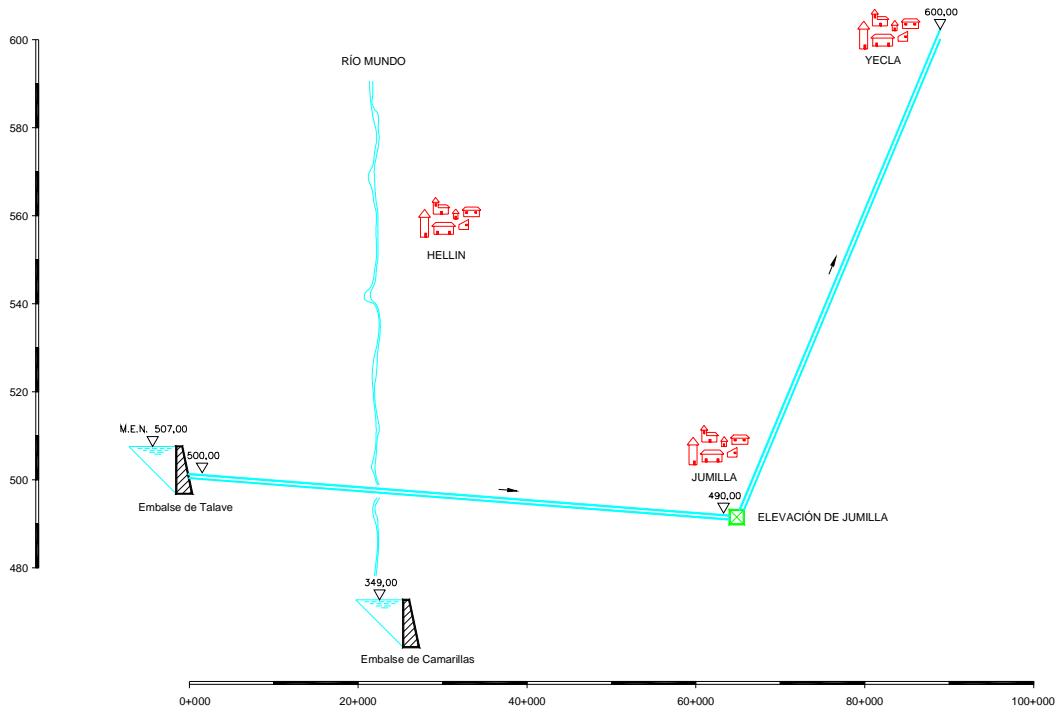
Conducción Talave-Altiplano. Esquema en alzado
